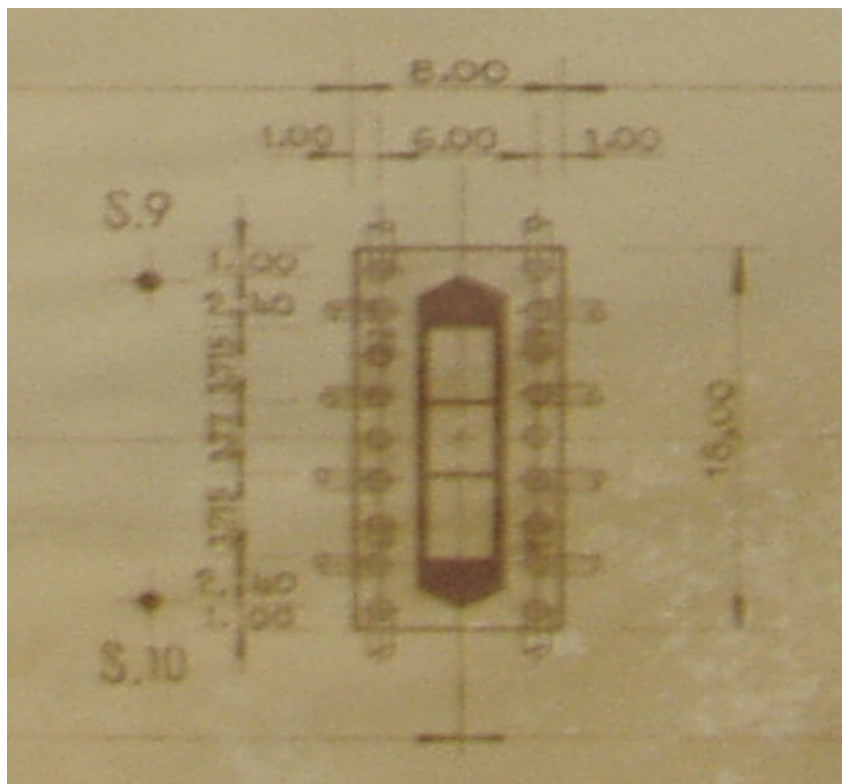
Vista em planta da fundação, Cardoso, Edgar (1963).
